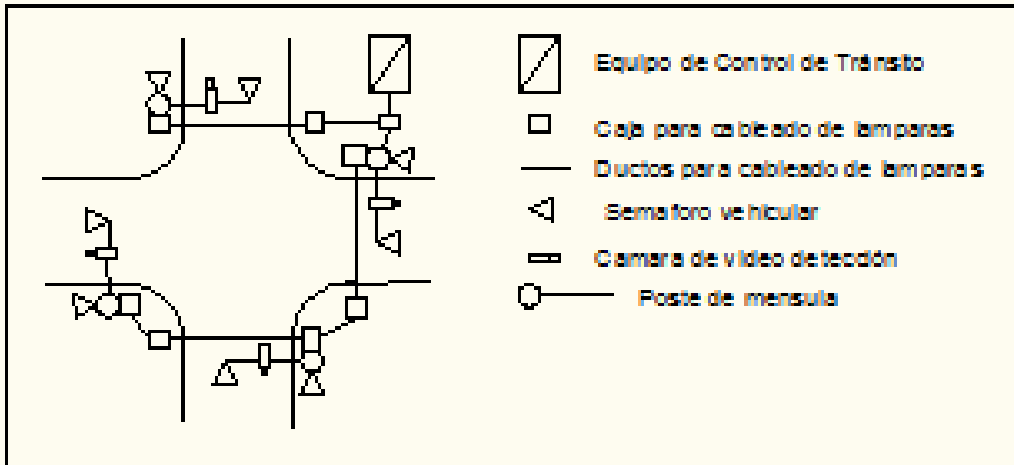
Configuración de las obras civiles para corriente abajo
